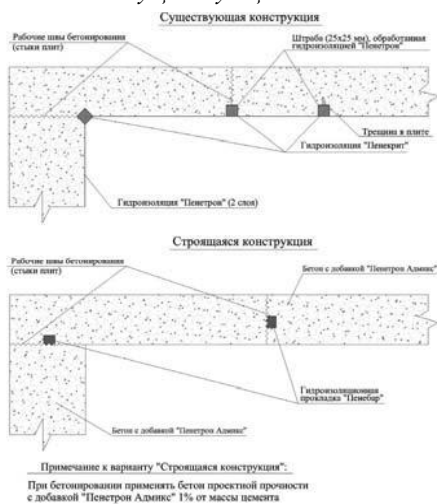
Устройство гидроизоляции в швах существующего монолитного перекрытия и строящейся конструкции при примыкании
